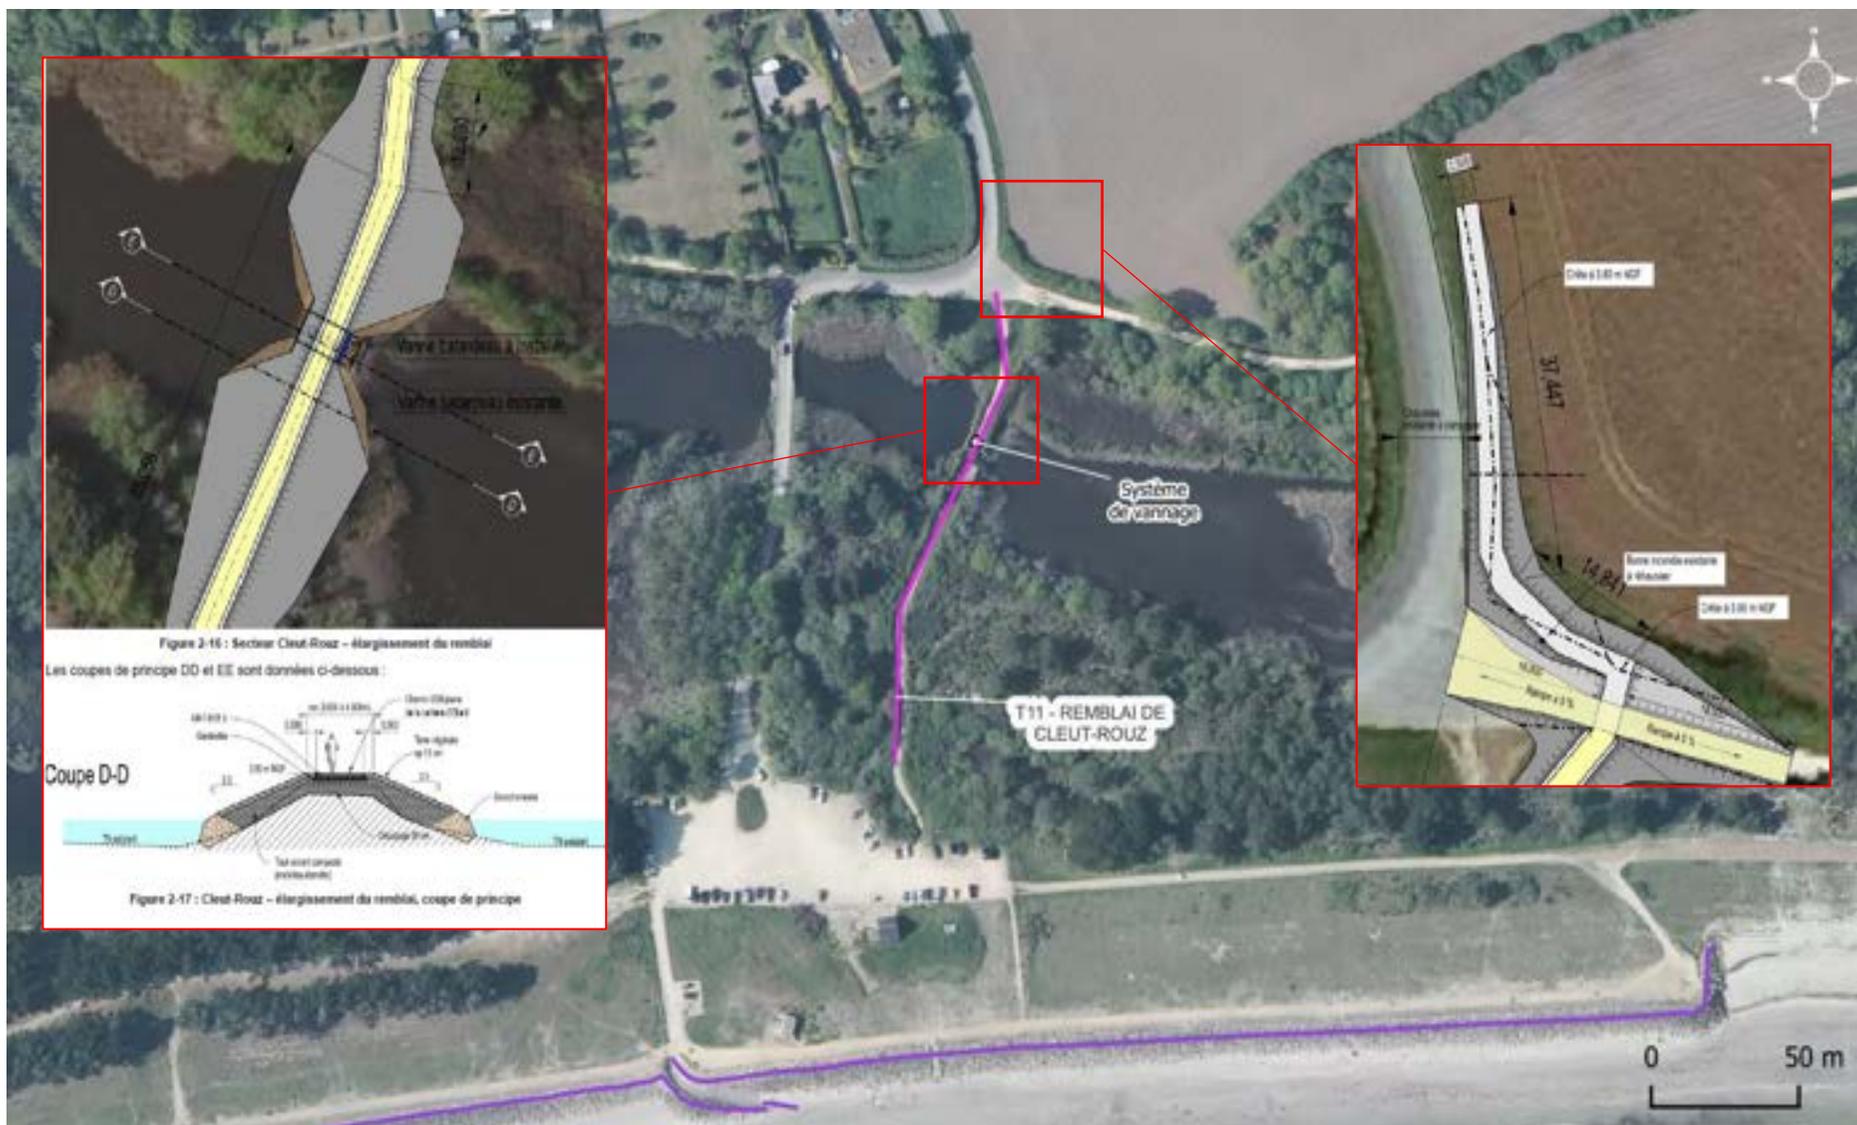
Travaux projetés sur le secteur de Cleut-Rouz, Système d'endiguement de Moustierlin – Ouest (Rapport d'Avant-projet, ISL Ingénierie, 2021)
